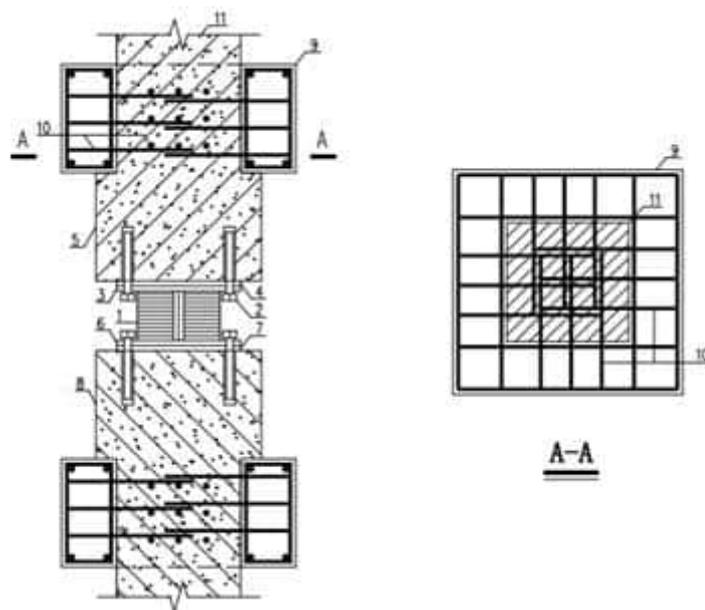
框架柱托换及隔震支座安装示意图（钢筋混凝土托换节点）
